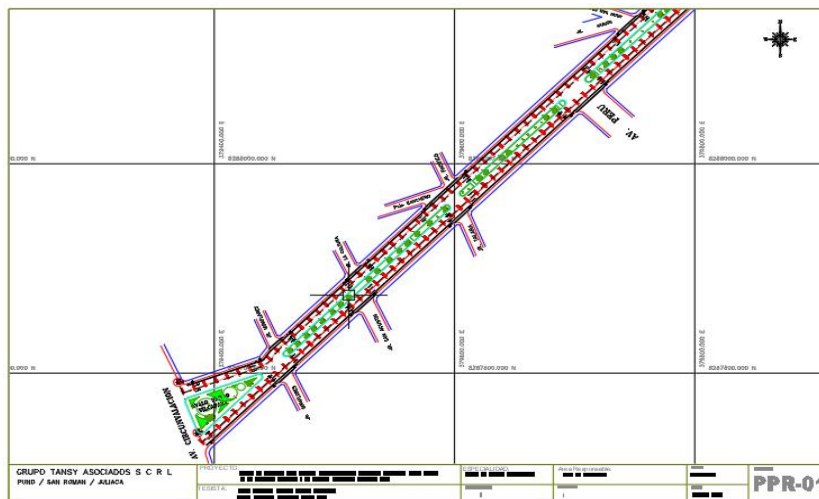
Plano de levantamiento topográfico general incluye ciclovía.
